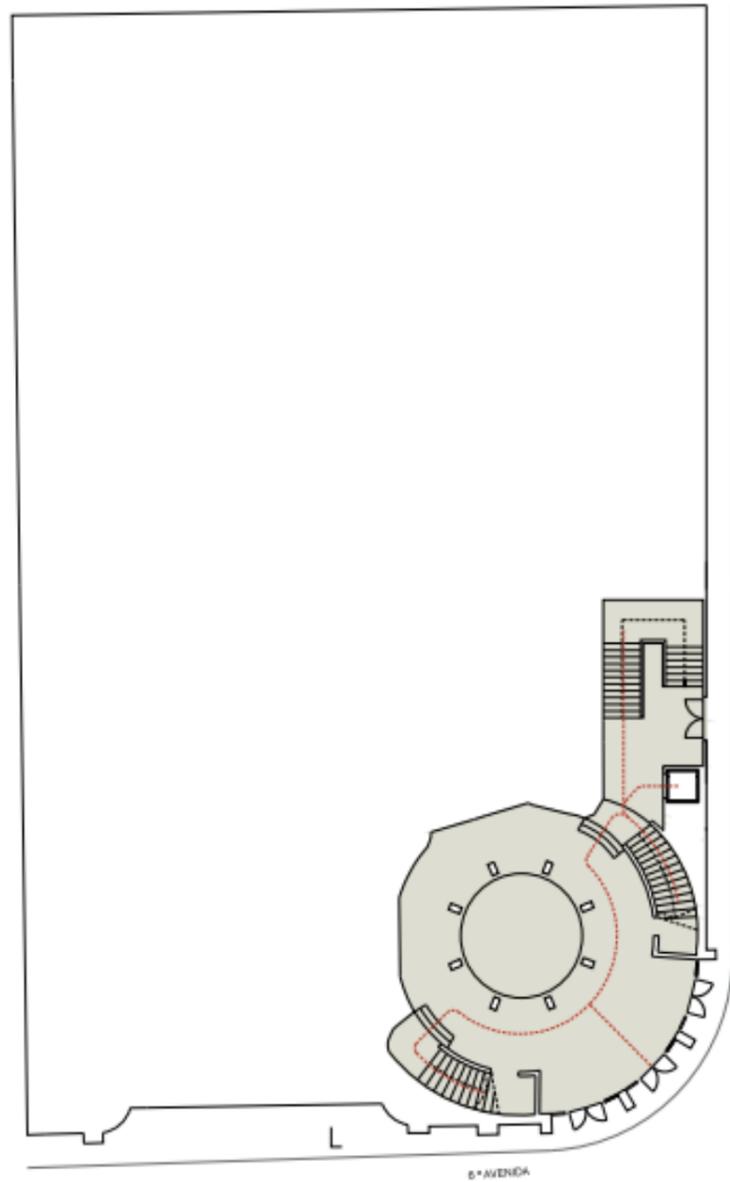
Planta arquitectónica Teatro LUX primer Nivel
